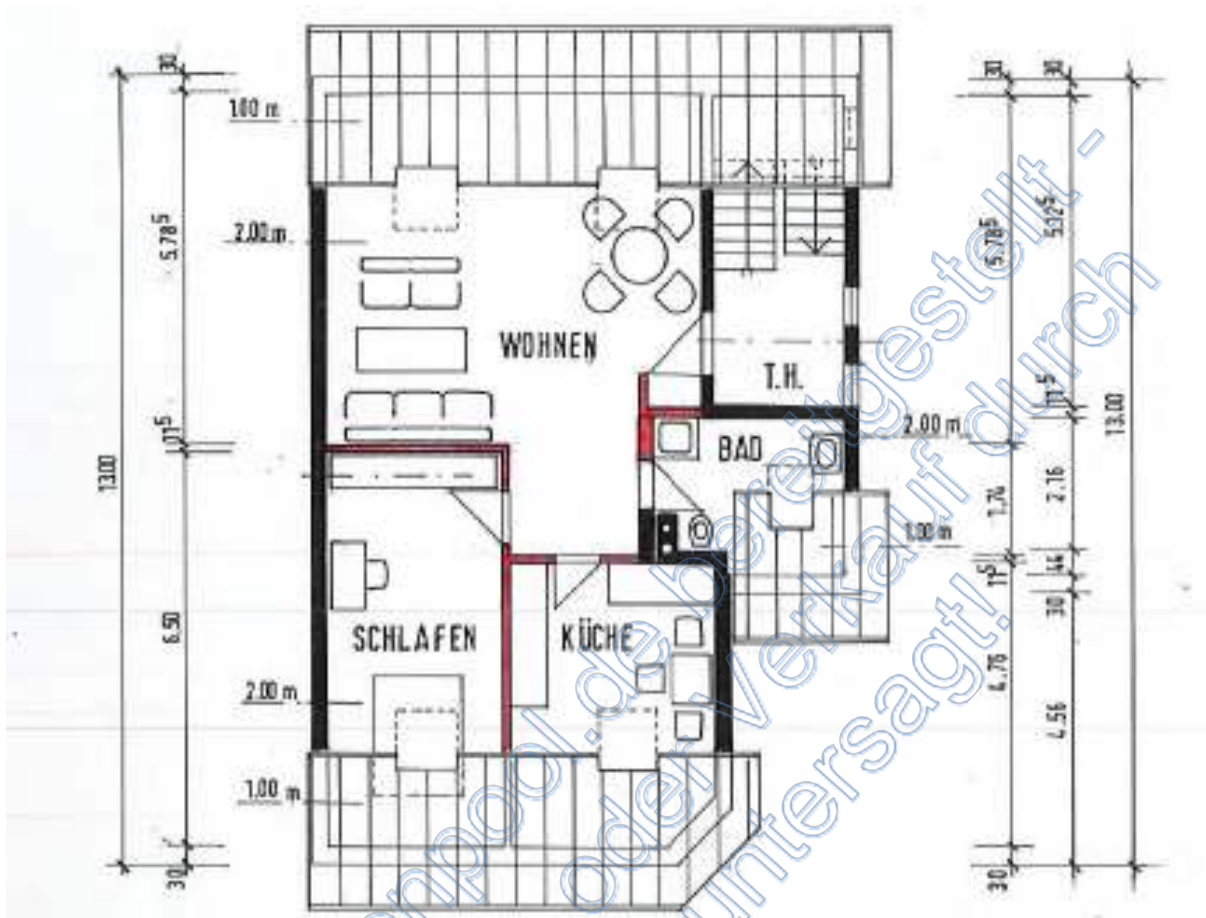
Grundrisse der Einliegerwohnung im Dachgeschoss
